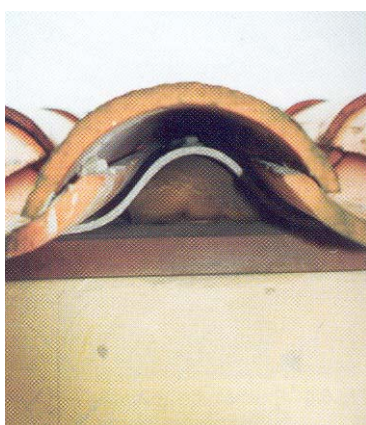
Pormenores de aplicação de subtelha com telha do tipo canudo.
